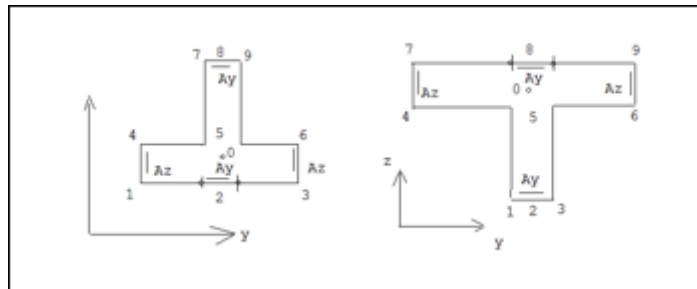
Fili fissi e armature distribuite per i pilastri a T
